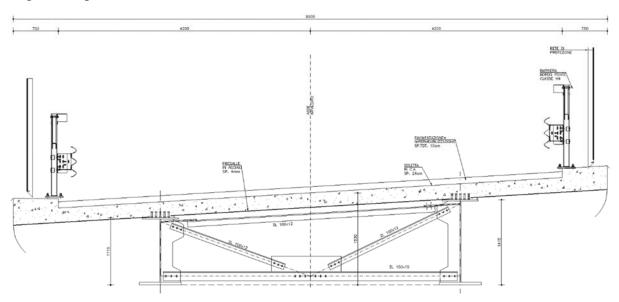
Sezione trasversale dell'impalcato nel tratto di larghezza 9.90 m
